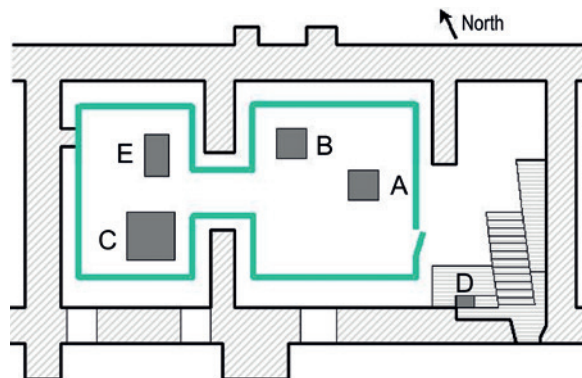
| Grundriss des gravimetrischen Labors Bad Homburg /Wilmes &amp; Falk 2006/
